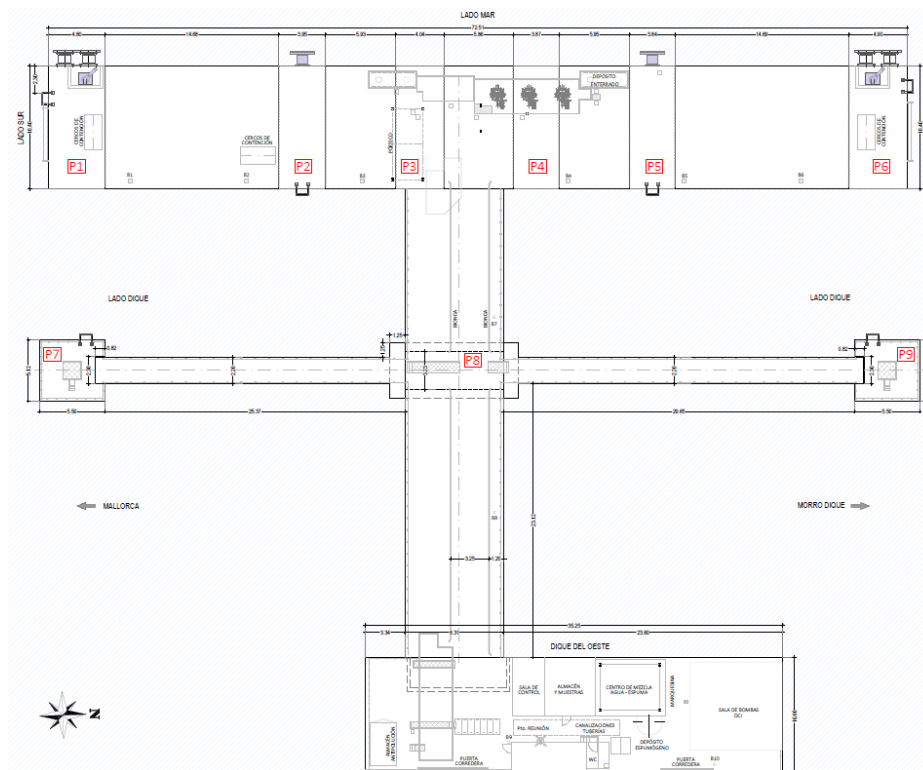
Planta aproximada y codificación de las pilas-cajón del Terminal
